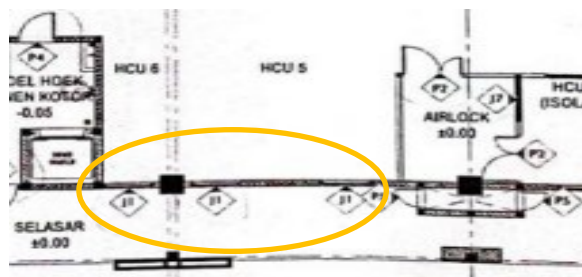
Denah Rencana Pintu Tipe PJ2.
